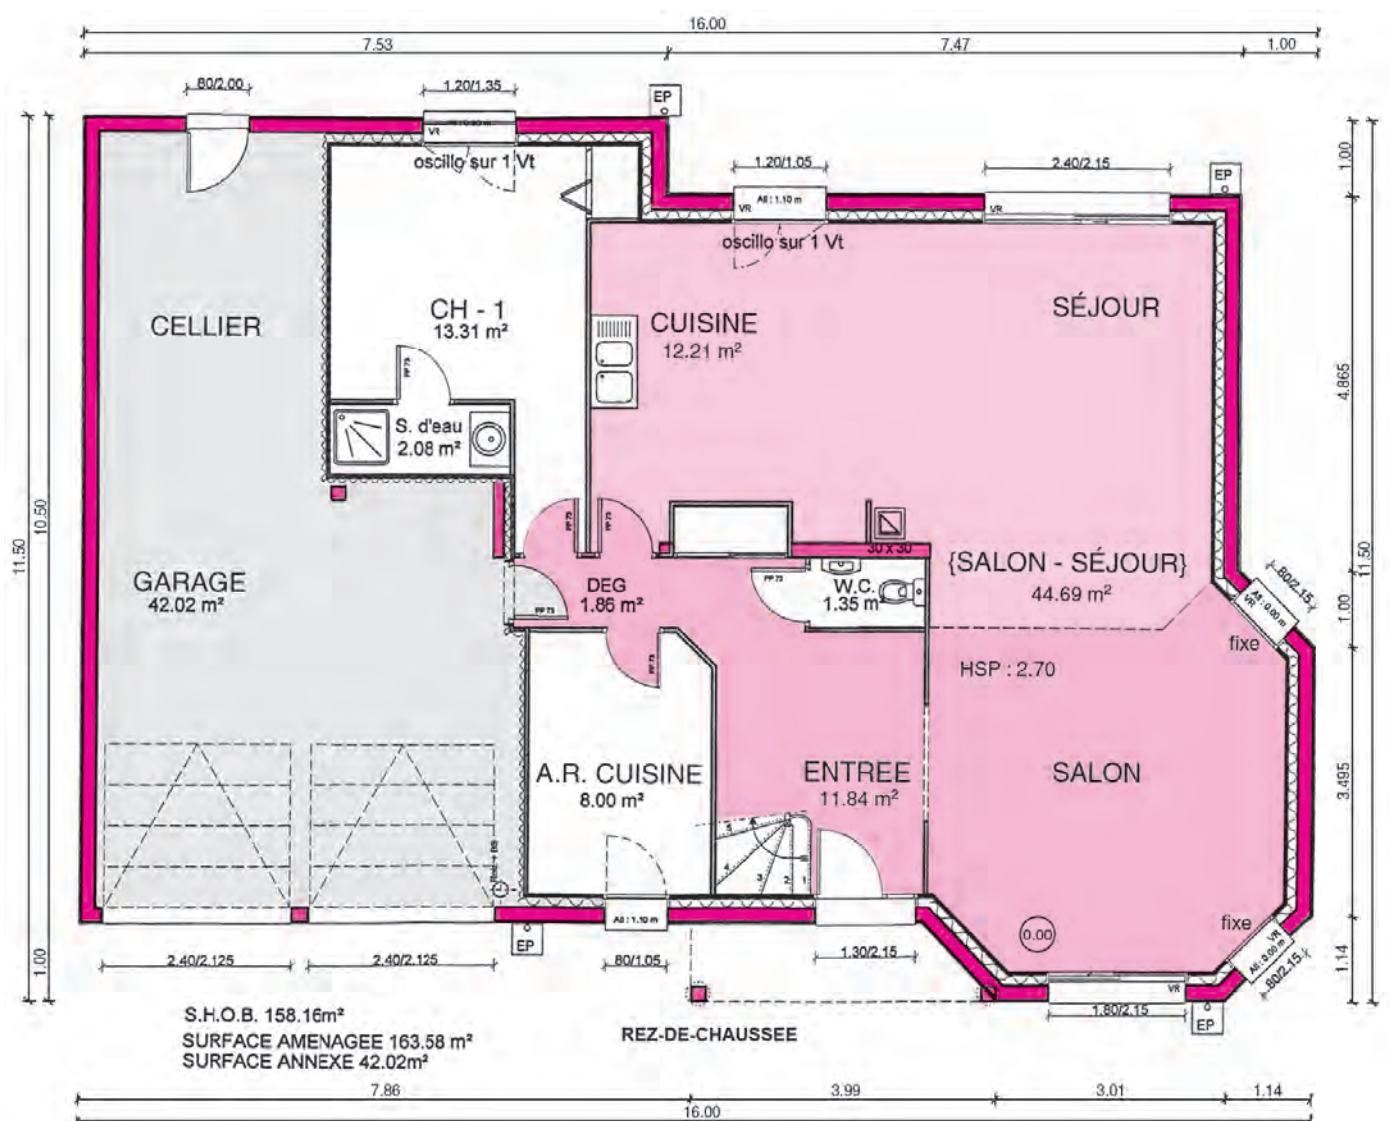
Avant-projet du plan du rez-de-chaussée
